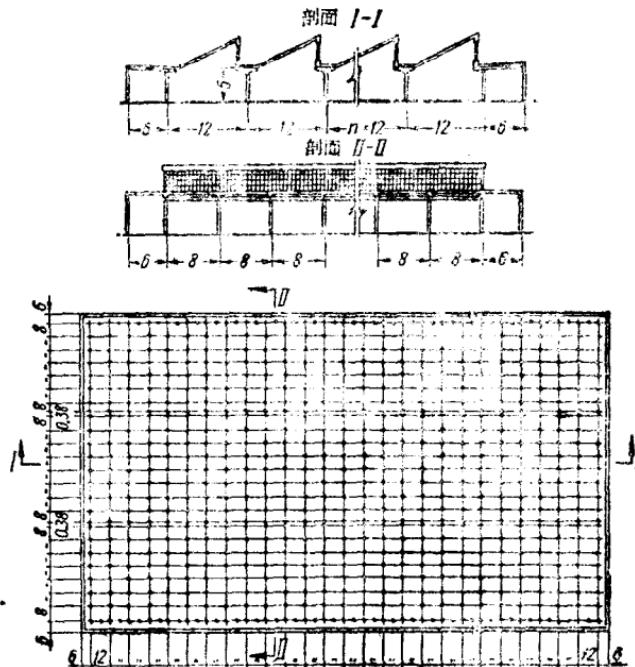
由 8×12 公尺定型区间拼合的厂房平面图及剖面图
